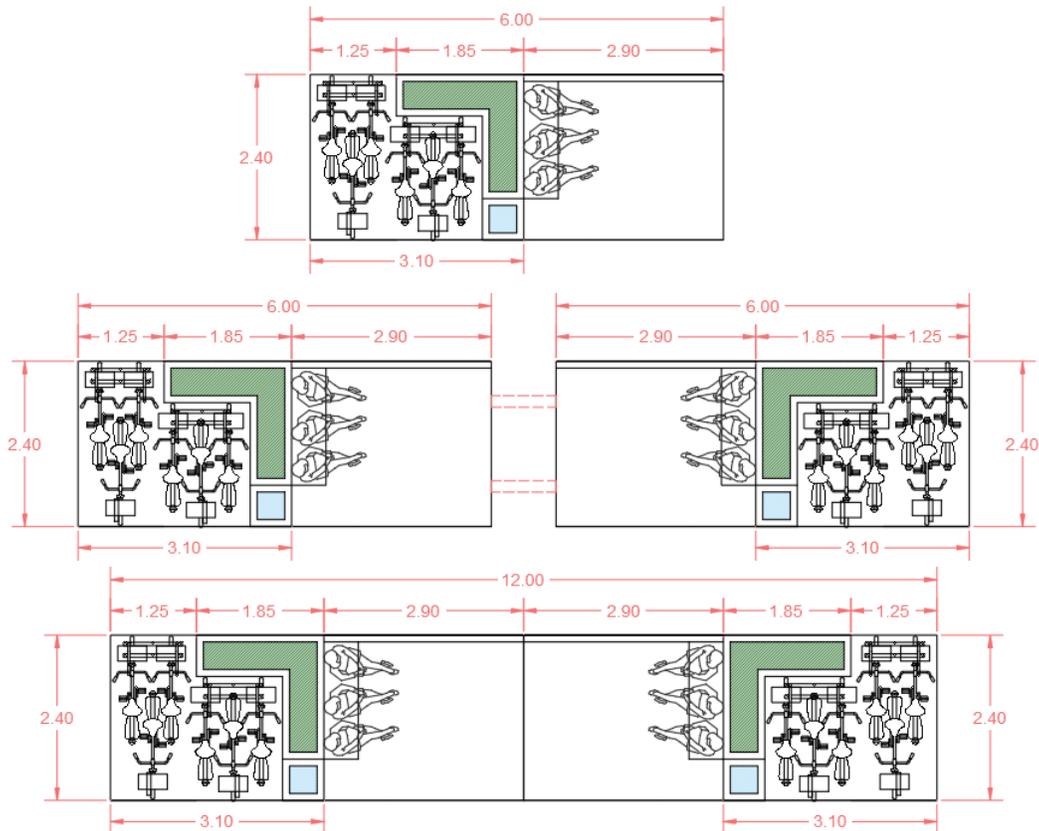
Patrón 1. Vista en planta arquitectónica (sin escala, medidas en metros)
